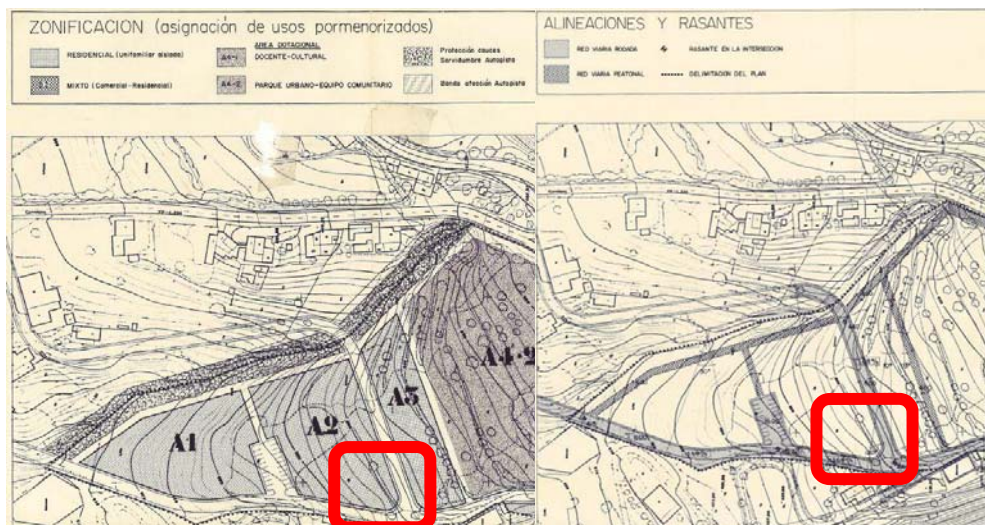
IMAGEN: PLAN PARCIAL LA BARANDA II. PLANOS DE ZONIFICACION Y ALINEACIONES. ZONA A2
